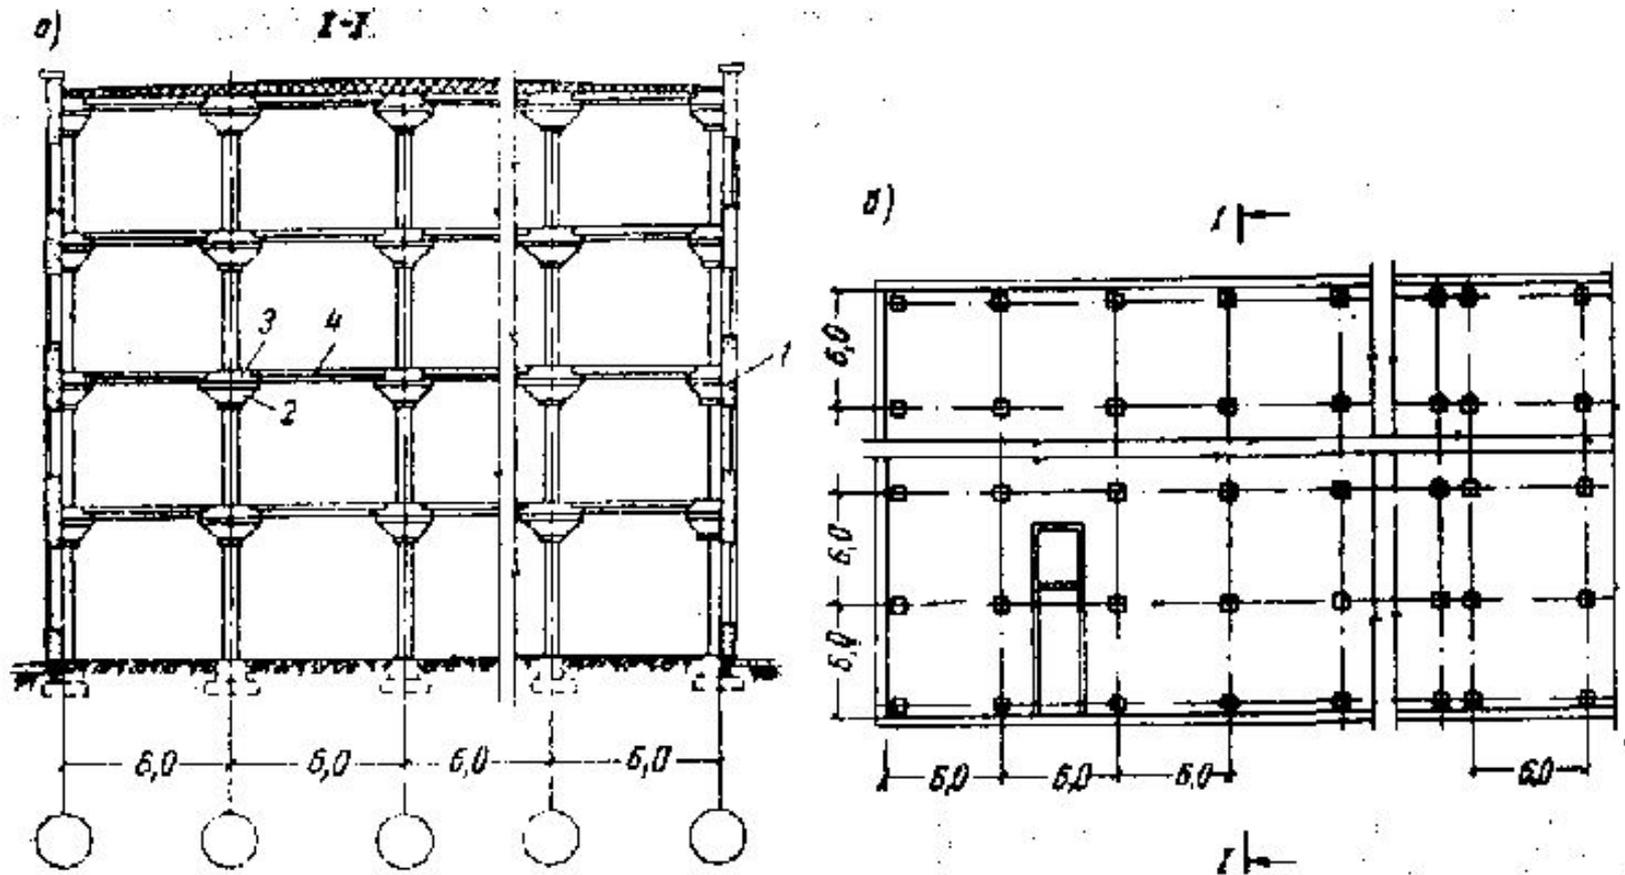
Многоэтажное здание с безблочными перекрытиями
